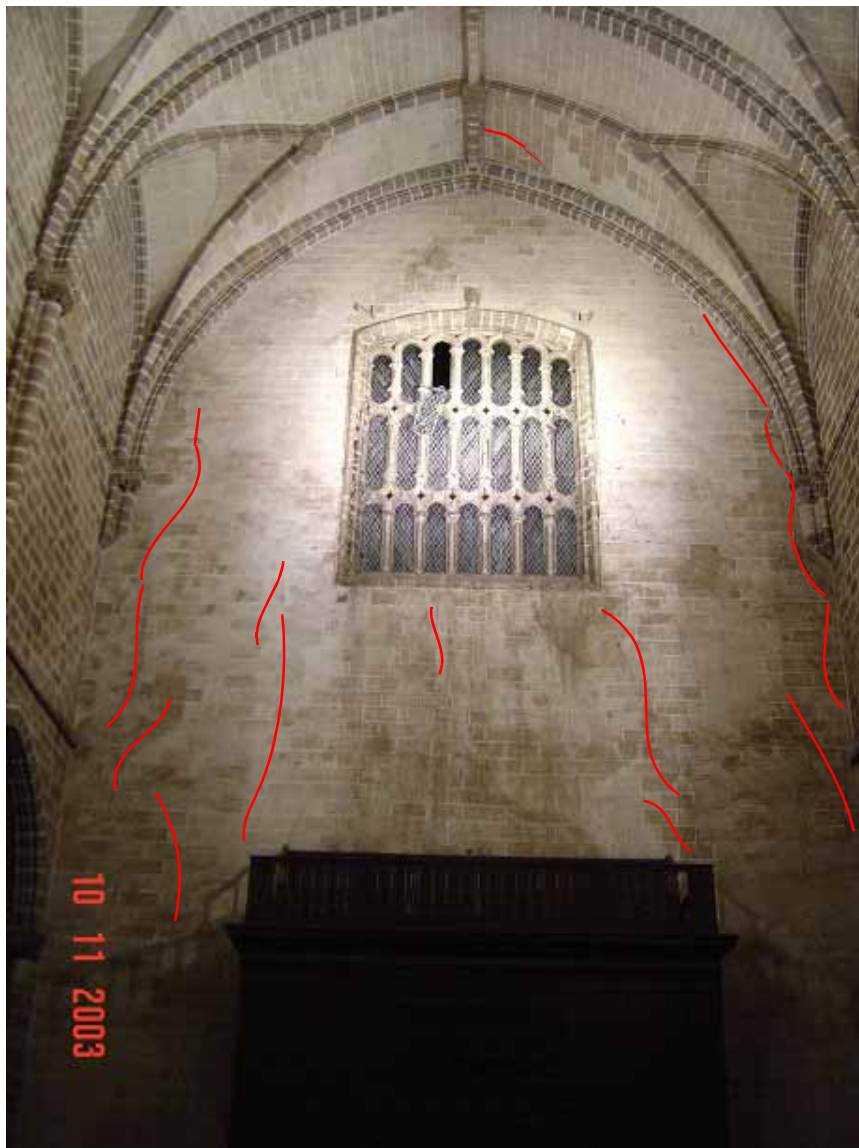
Levantamento da fendilhação da fachada principal da Igreja de São Francisco - vista interior.
